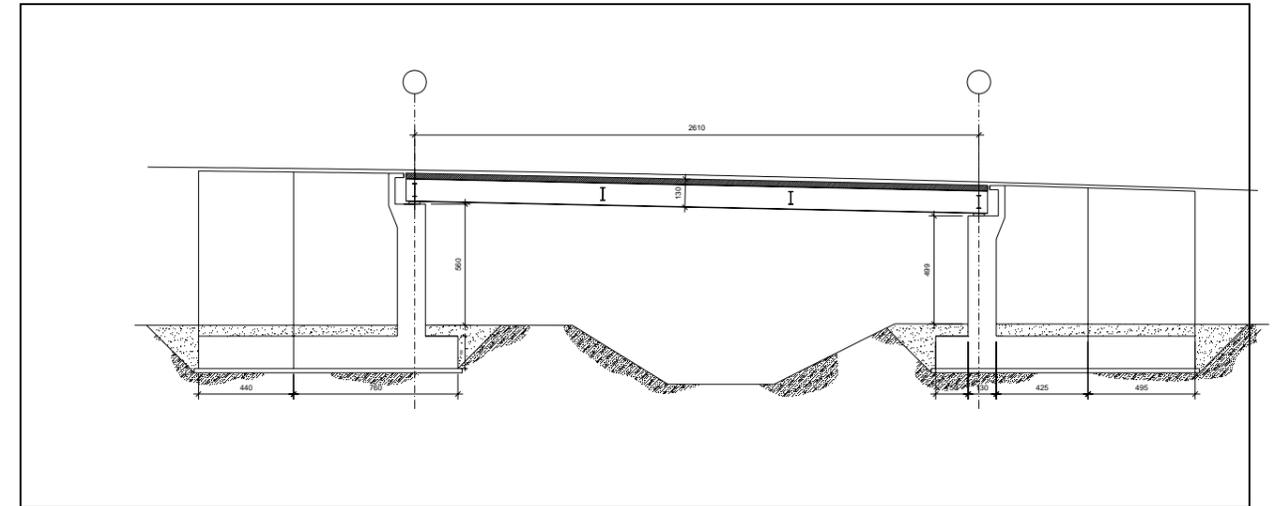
Ponticelli di attraversamento del canale esistente: Sezione longitudinale
